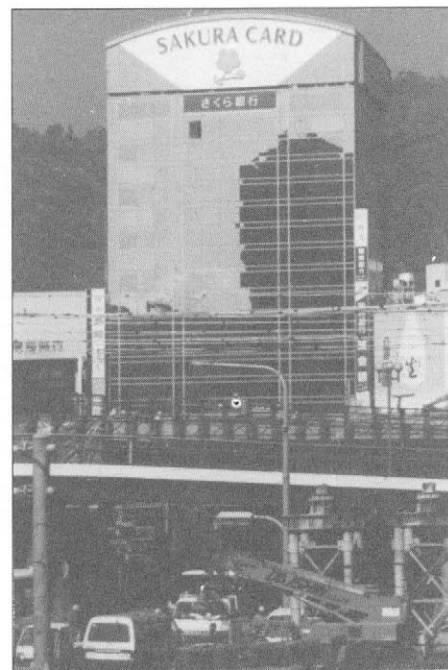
Moderne stanovanjske stavbe z jekleno konstrukcijo
